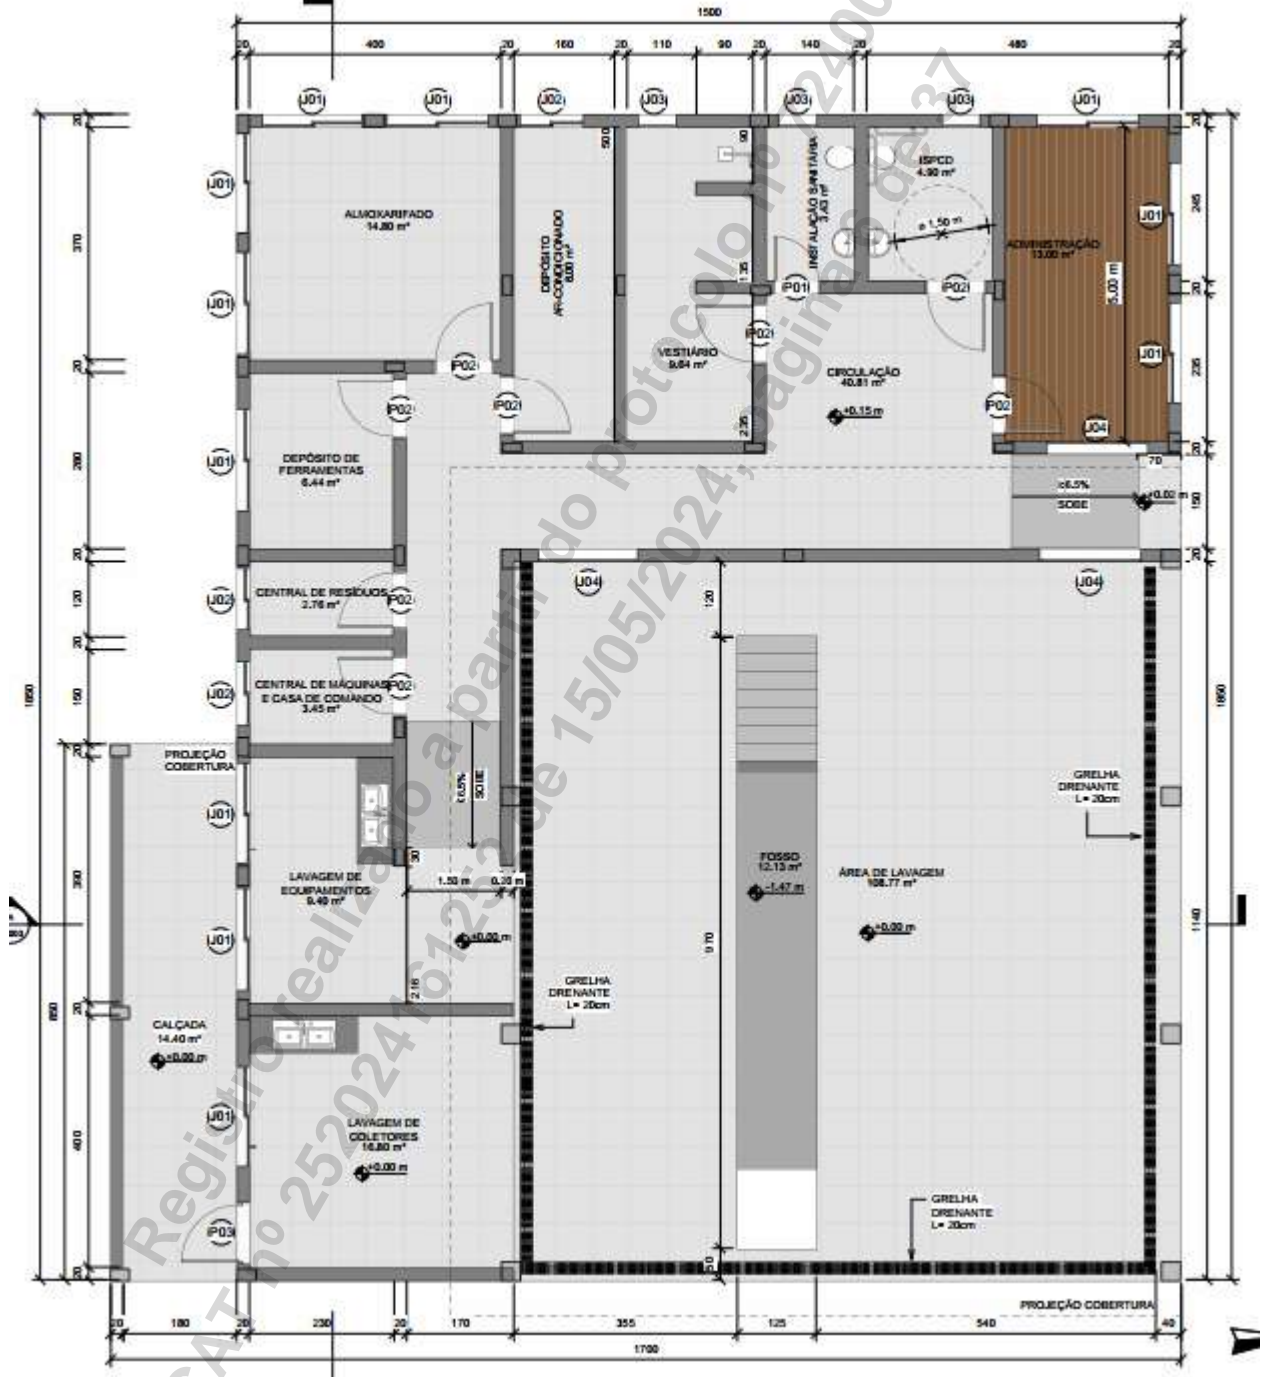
Planta Arquitetônica – Área de Lavagem de Equipamentos
